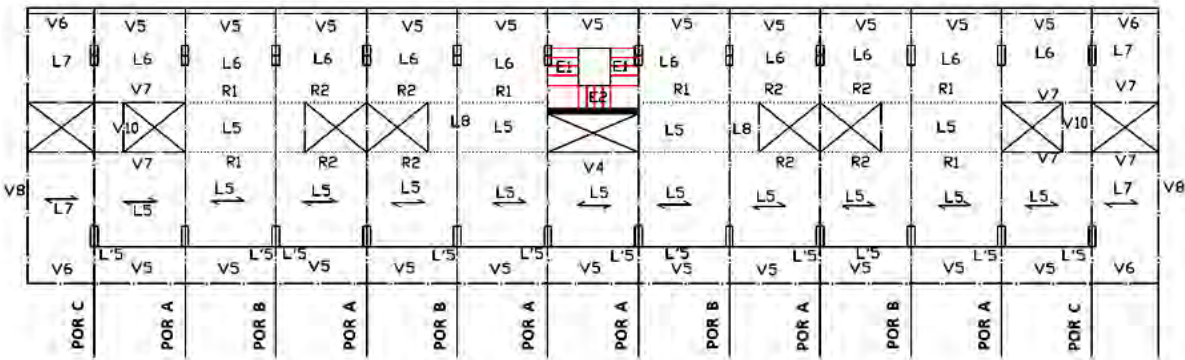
Planta estrutural dos pisos 2, 4, 6 e 8.
